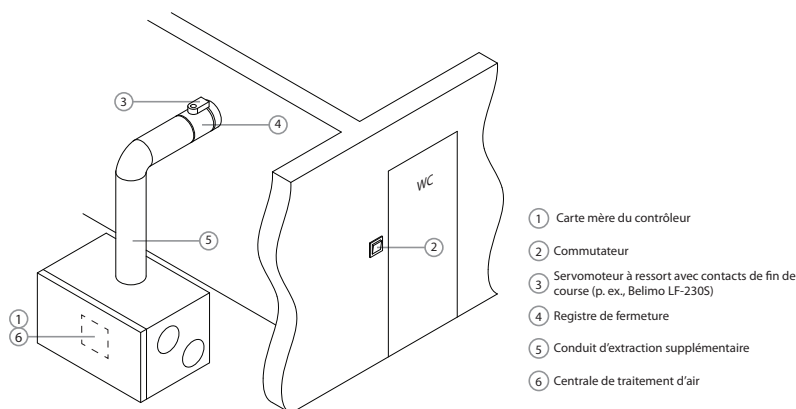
Exemple de montage d'un conduit d'extraction d'air supplémentaire
